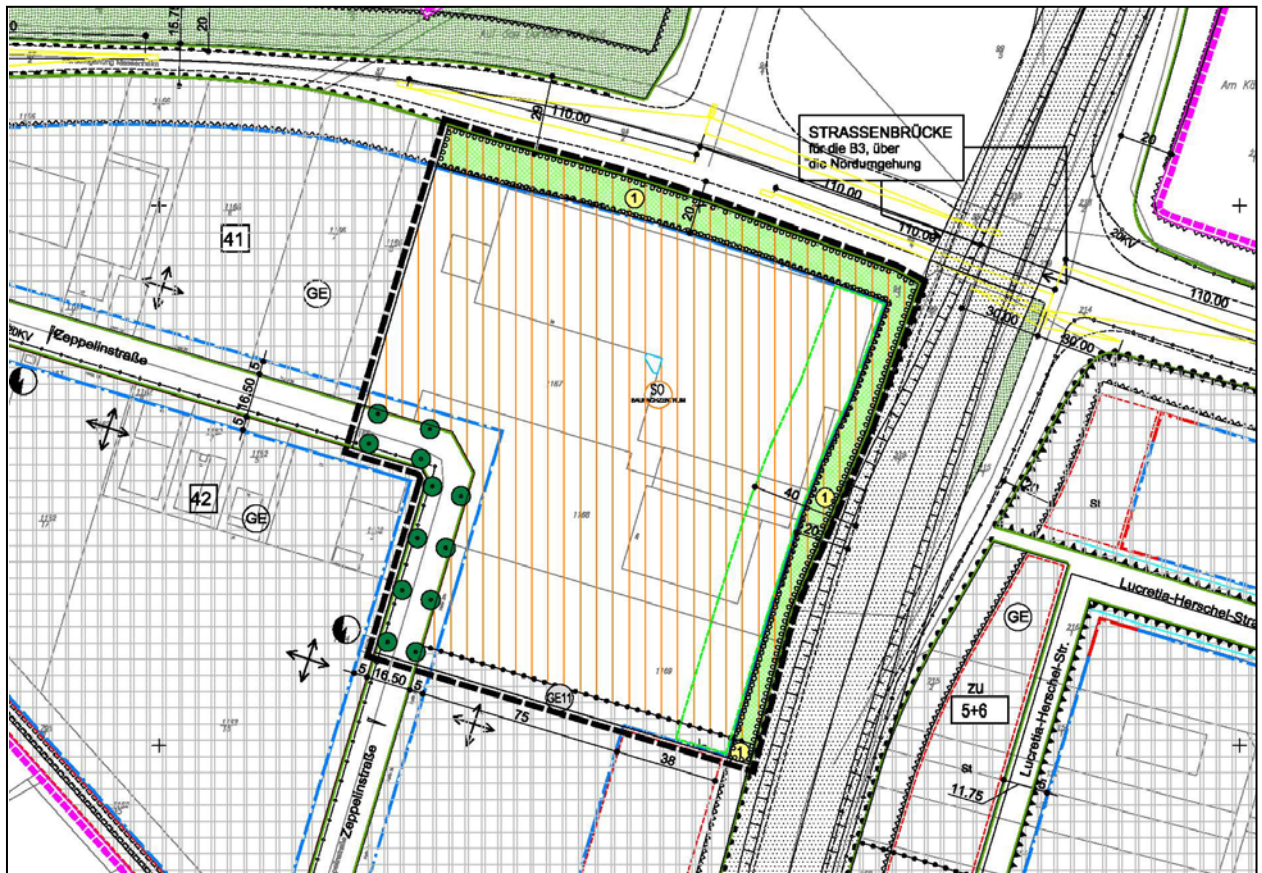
Bebauungsplan „5. Änderung Krebschere“
